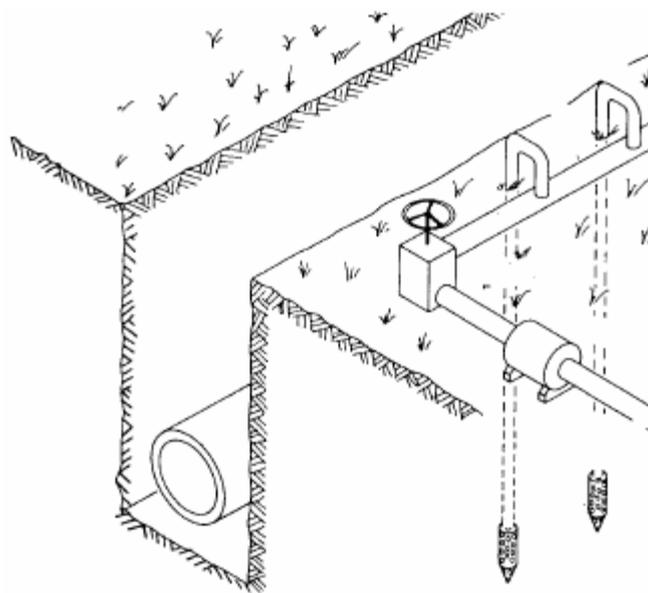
Vista en perspectiva del sistema de punteras Wellpoints
